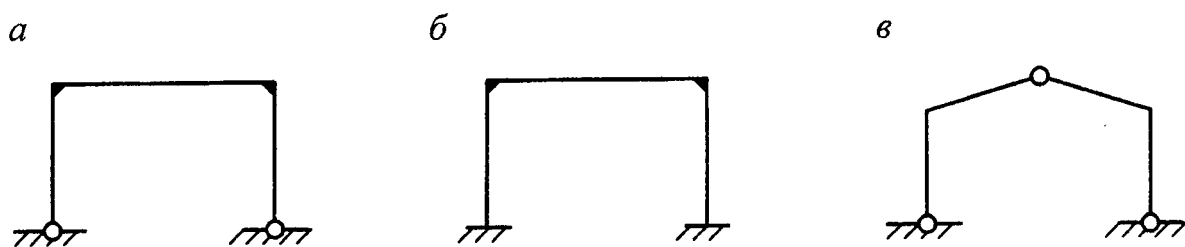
Схемы поперечных рам одноэтажных промышленных зданий:
